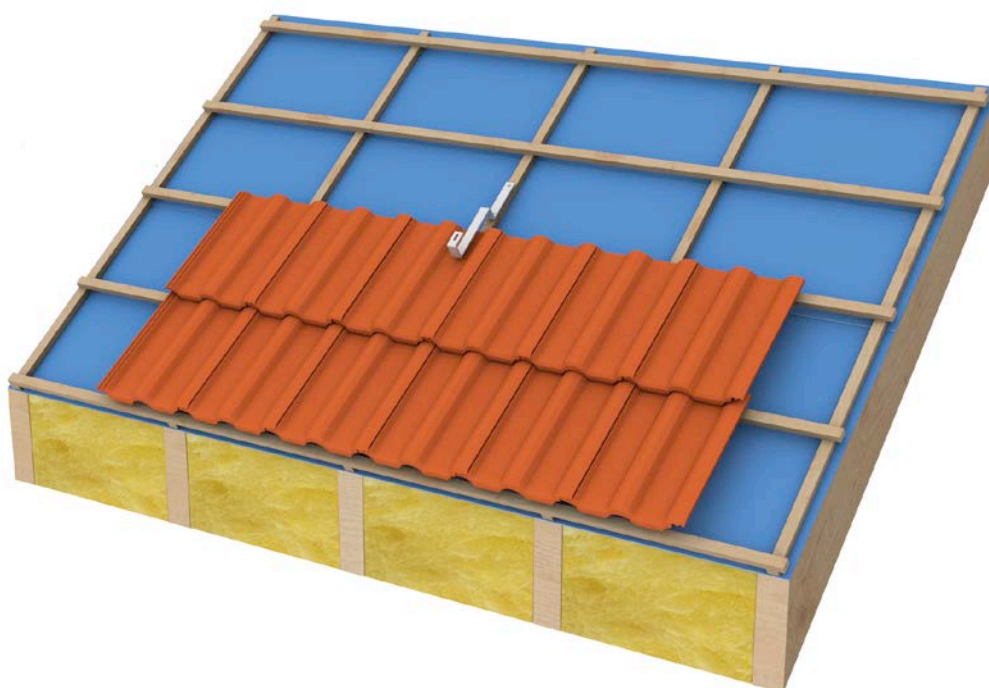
Fixation d'un crochet au droit d'un élément de la charpente.
